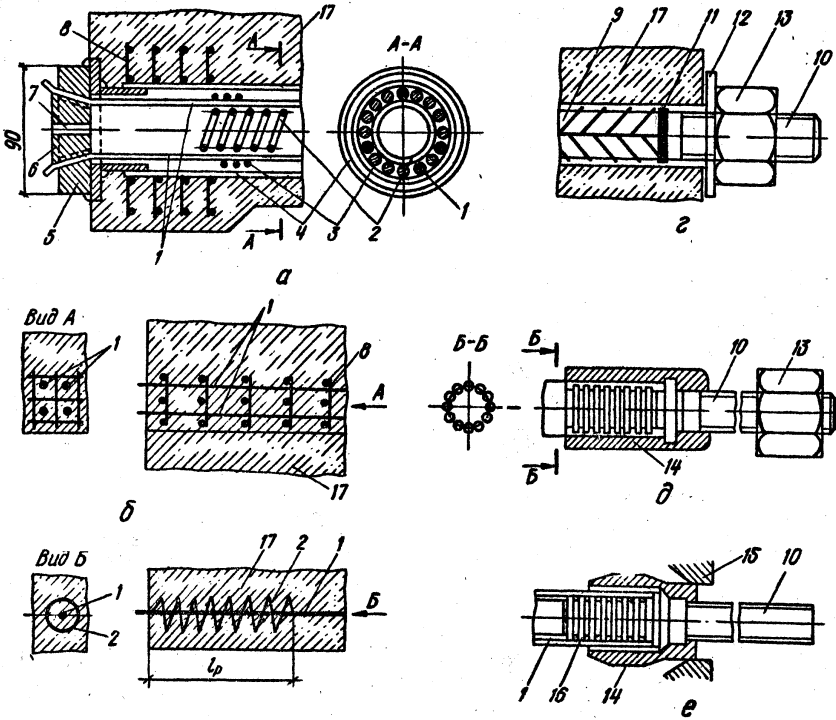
Анкерування напружуваної арматури: *а, д* – з пучків високоміцного дроту; *б* – поперечними сітками біля опор; *в* – те саме, спіралями; *г* – стержневої арматури; *е* – обтискування пучка гільзою; 1 – високоміцний дріт; 2 – спіраль; 3 – скрутень з тонкого дроту; 4 – оболонка каналу в бетоні; 5 – колодка анкера; 6 – конічна пробка; 7 – отвір для ін'єкції каналу; 8 – сітки непрямого армування; 9 – напружуваний стержень; 10 – оцупок з різью; 11 – зварювання; 12 – шайба; 13 – гайка; 14 – обтискувана гільза; 15 – обтискне кільце; 16 – виточки на оцупку; 17 – бетон
